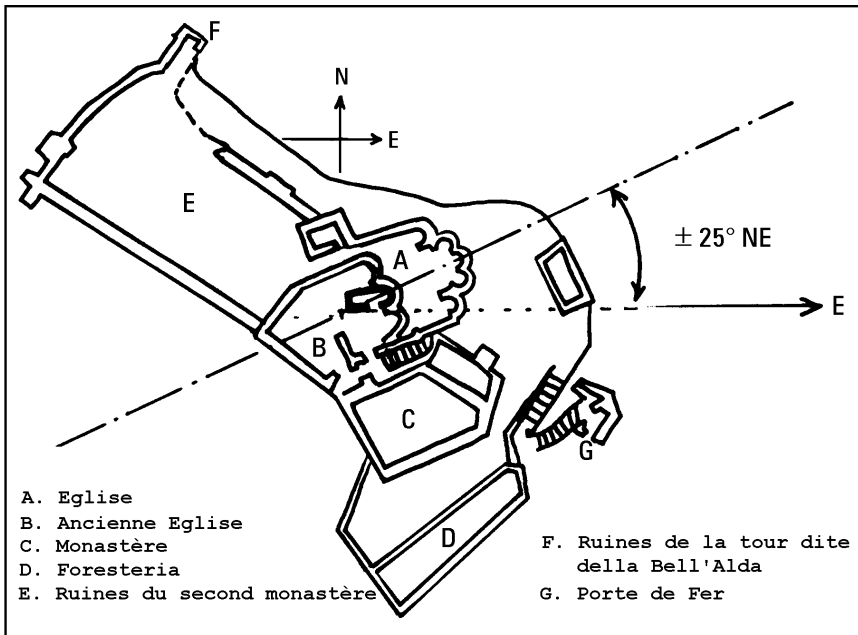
Plan des constructions de la Sacra, d'après l'Architecte D'Andrade
